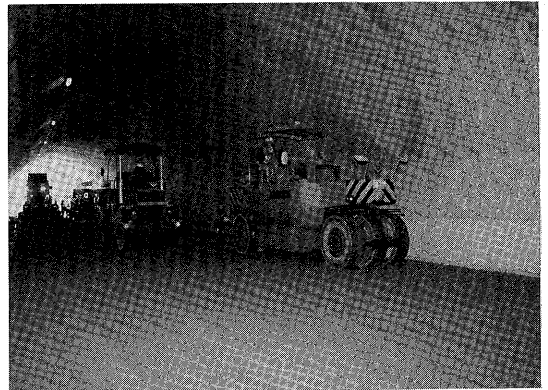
転圧コンクリート施工状況 (山根トンネル下り)
